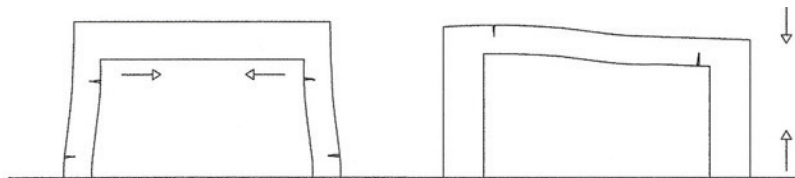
Esquemas de fisuración de pórticos de hormigón armado originados por la contracción térmica o higrotérmica de alguno de sus elementos.
